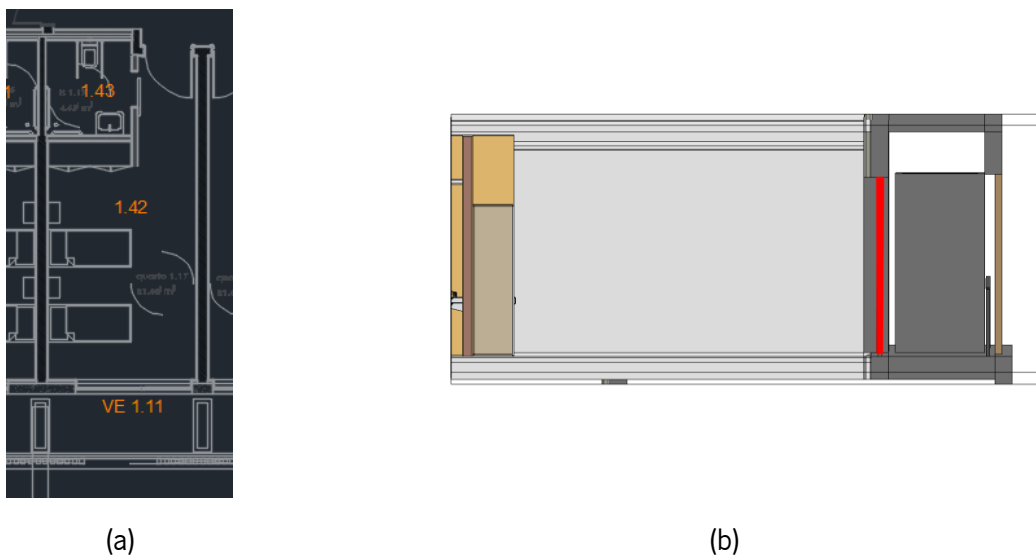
Localização do vão envidraçado VE 1.11, na planta (a) e em alçado, a vermelho (b).
